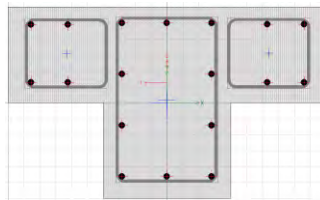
Refuerzo de la columna C-2 para sistema dual
